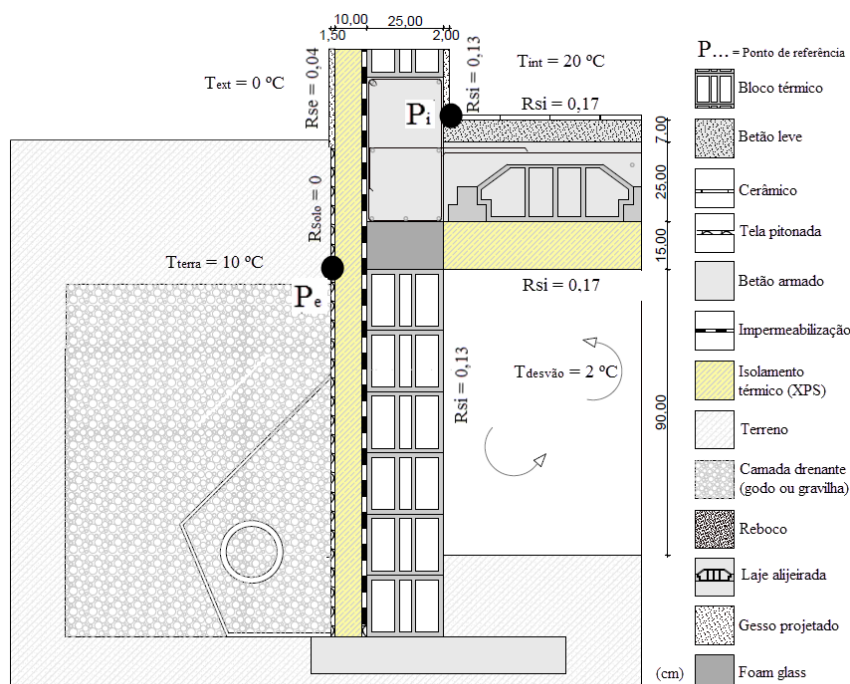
Ligação de fachada (parede simples) com laje de piso sobre desvão ventilado
